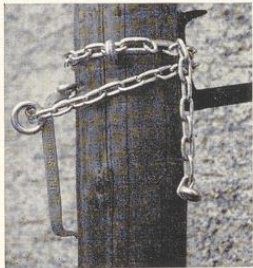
Befestigung der Stellstange am Mauerhaken mit dem Kettenspanner
